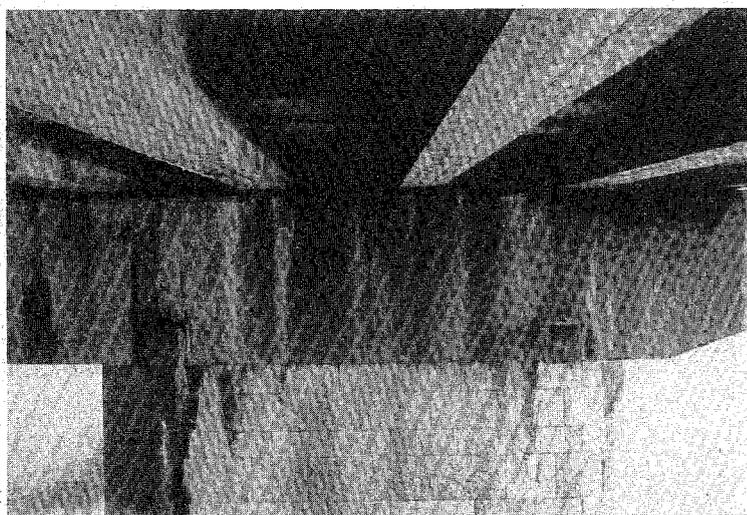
Conséquences sur une pile d'un défaut d'étanchéité du joint de chaussée.
